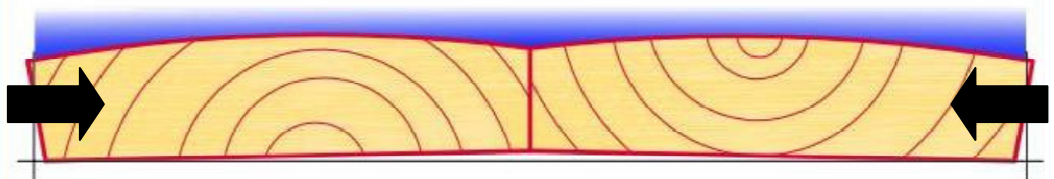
Effetto sulle liste di legno (correttamente posate) di un'eccessiva secchezza del massetto (ad es. accensione del riscaldamento a pavimento).
